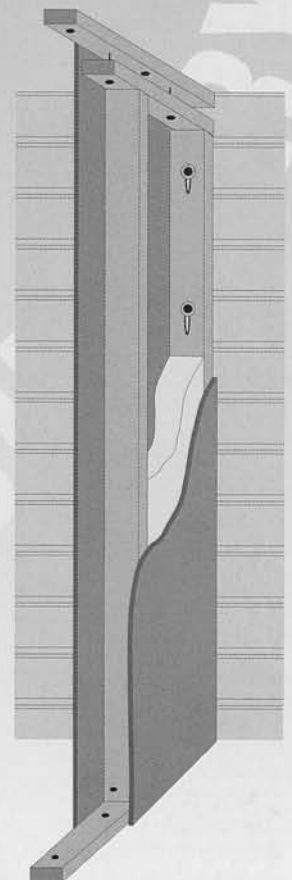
Пример соединения лёгкой каркасной перегородки с бревенчатой стеной.
